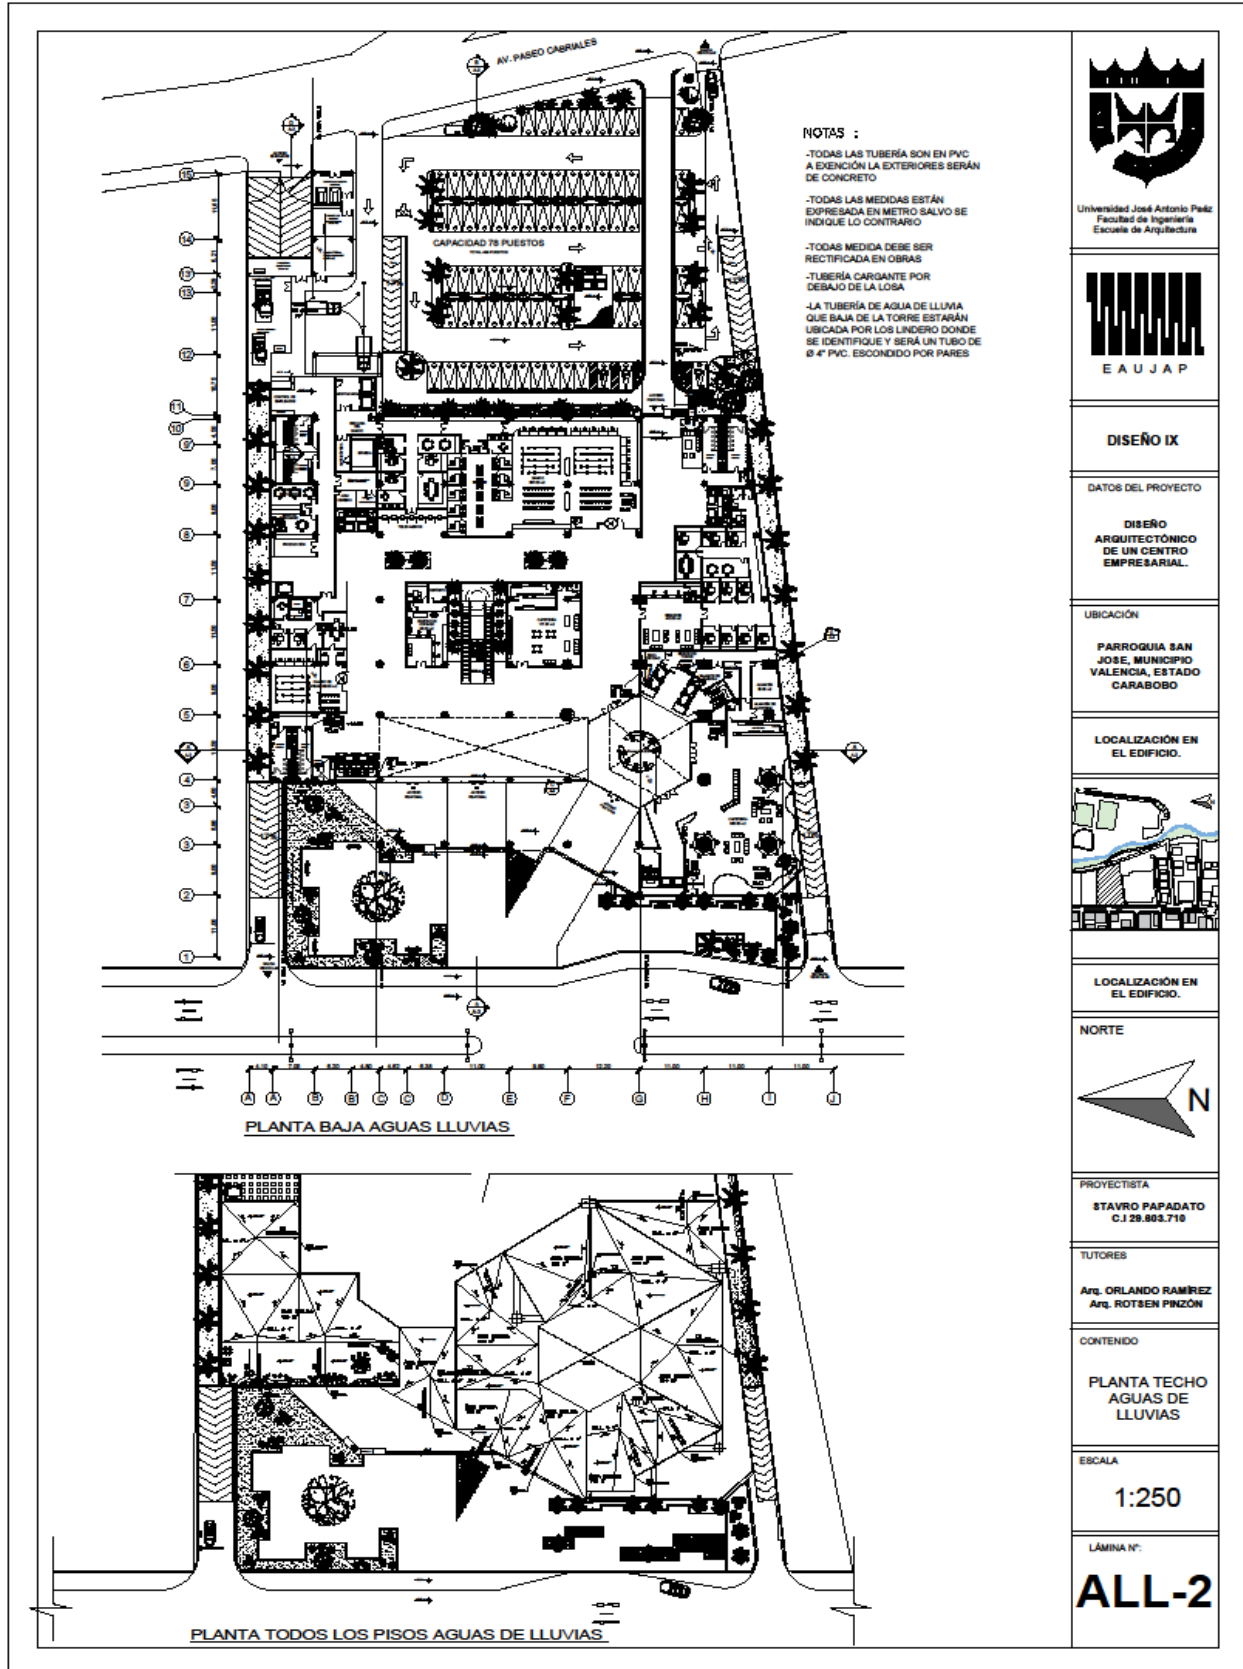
ALL-2 Planta Techo Aguas de Lluvias. Fuente: El Autor(2023)
